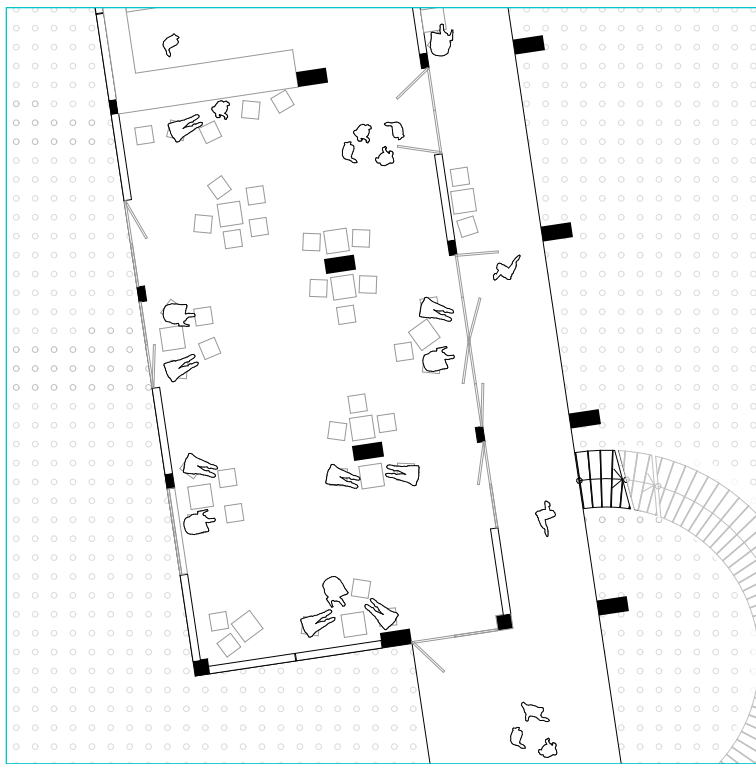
Ausschnitt Grundriss 0. Ebene 1:200
